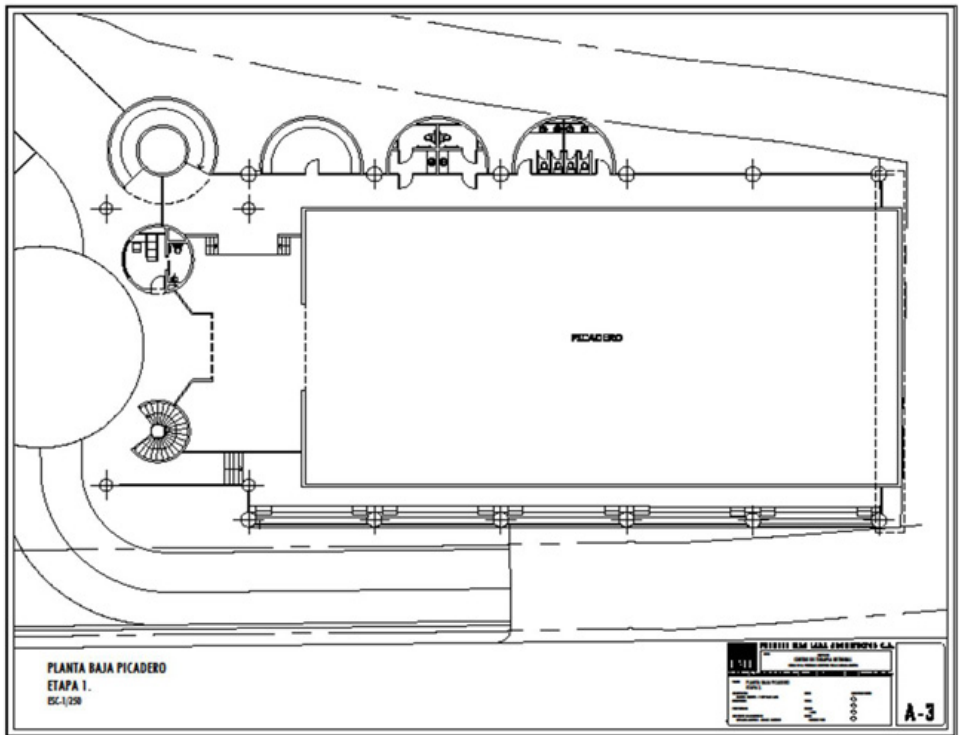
Plano de planta baja del picadero de la Fundación CITV.
